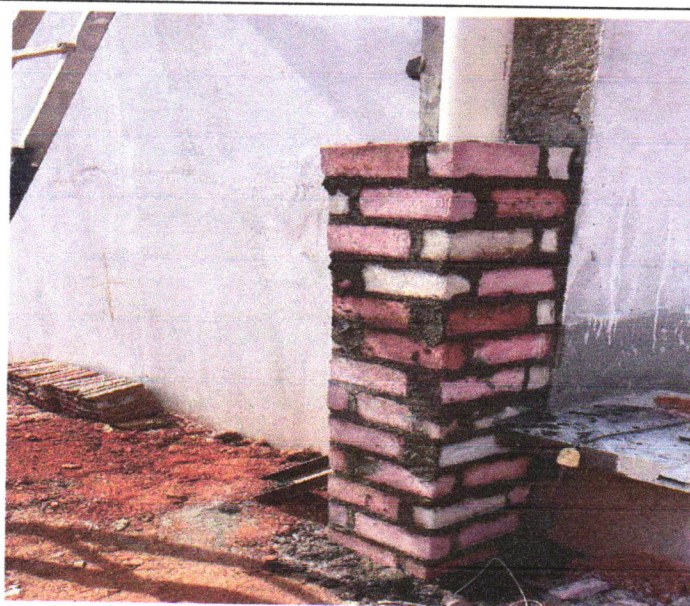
ASSENTAMENTO TIJOLO MACIÇO
